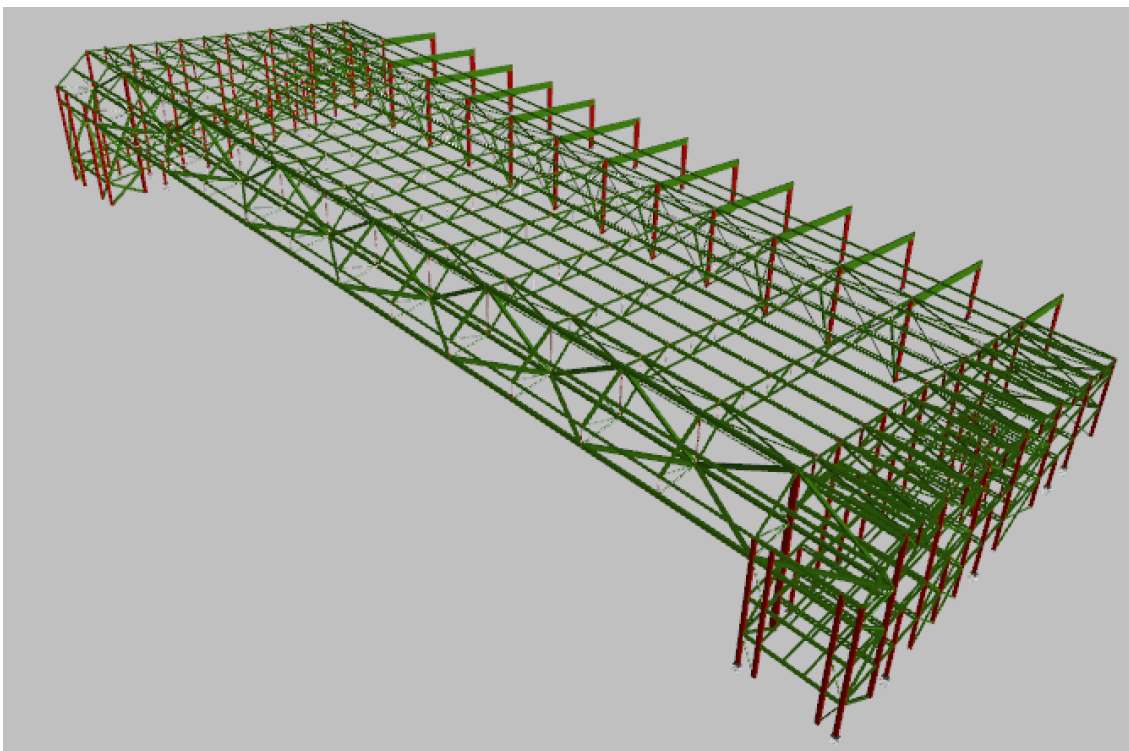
Modelo estructural del Edificio – vista 3D sureste.
